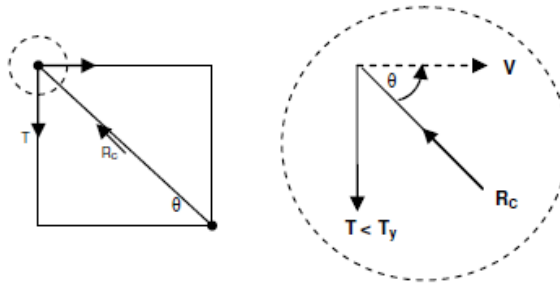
Equilibrio del nudo superior de un muro de albañilería confinada modelado como un sistema puntal-tensor (Cabezas, 2011).
